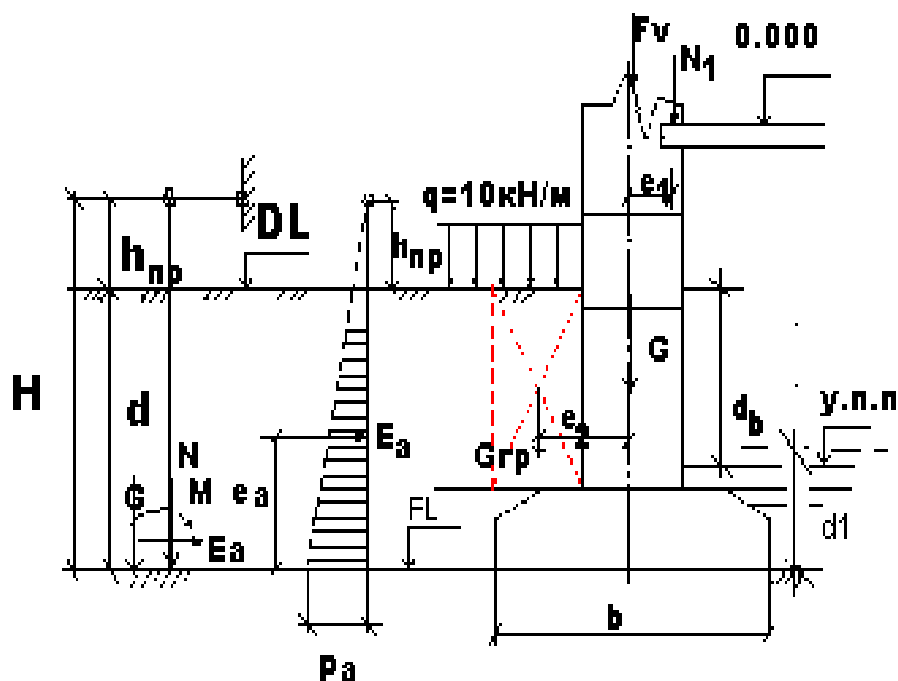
Расчетная схема ленточного фундамента при наличии подвала.
